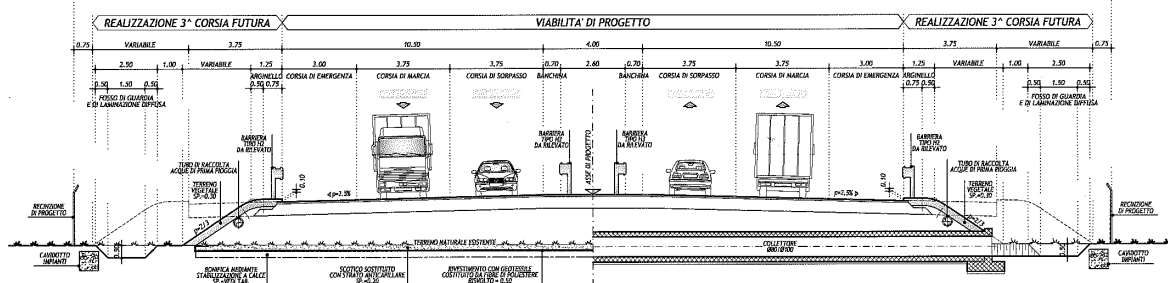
SEZIONE TIPO IN RETTIFILLO
